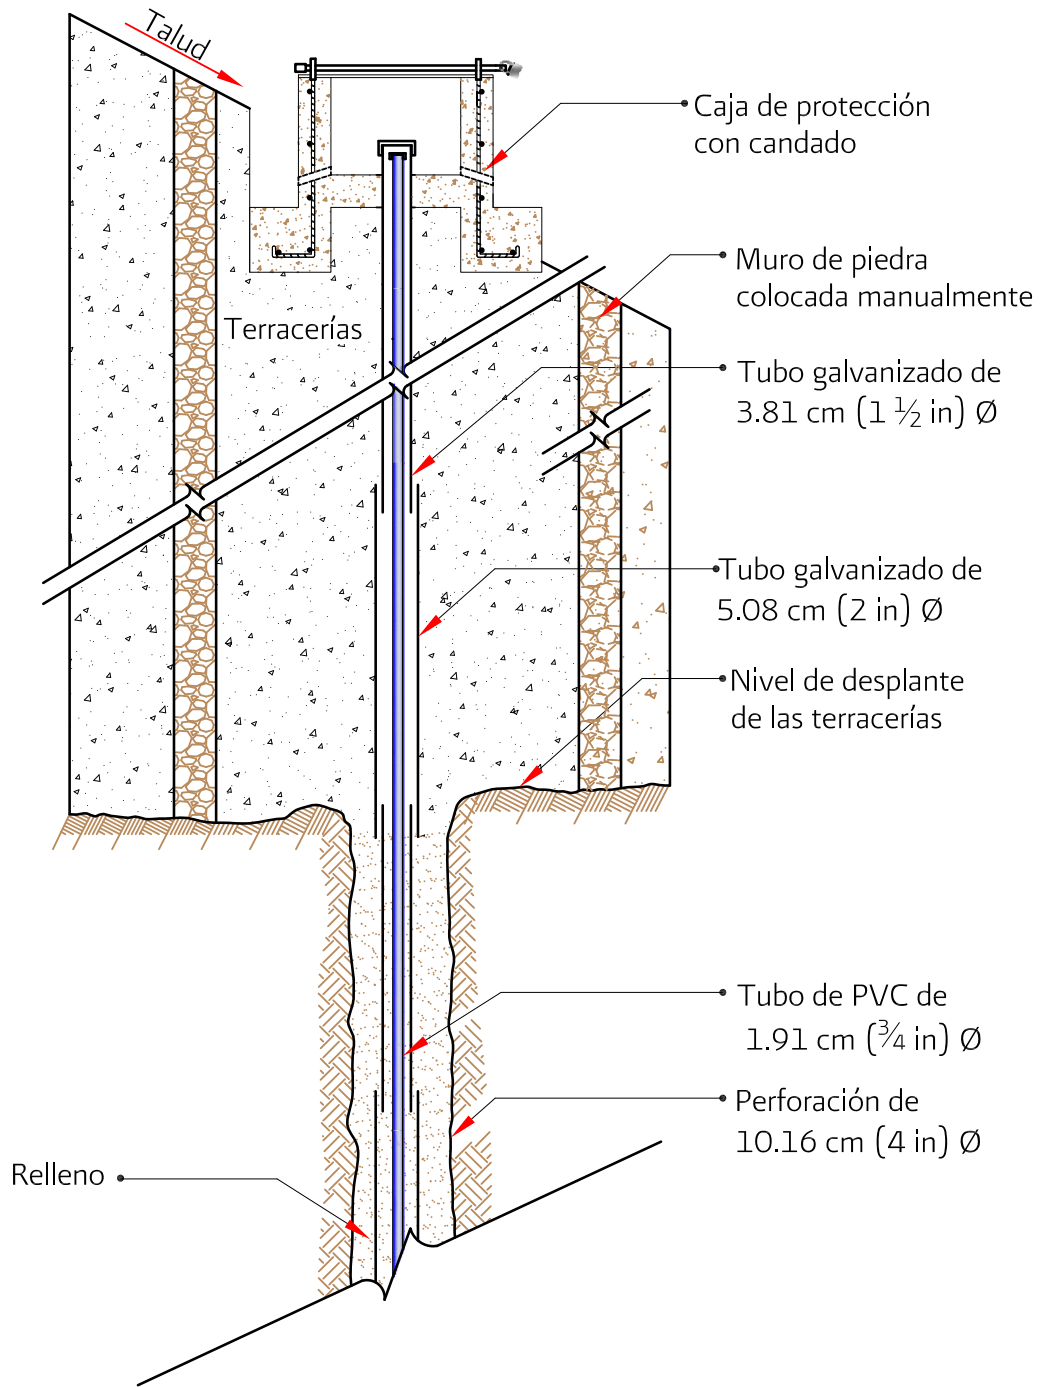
Protección de tubería de piezómetro abierto que atraviesa materiales gruesos de rezaga o rocas en respaldo
